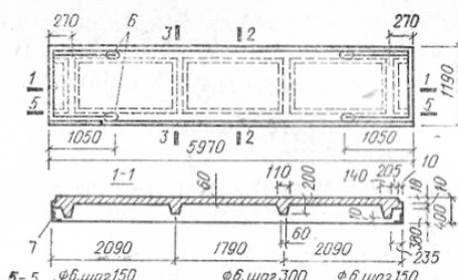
Армирование ребристой панели перекрытия сварными сетками и каркасами: 1-5 – каркасы и сетки; 6 – петли; 7 – уголок 125x80x8
